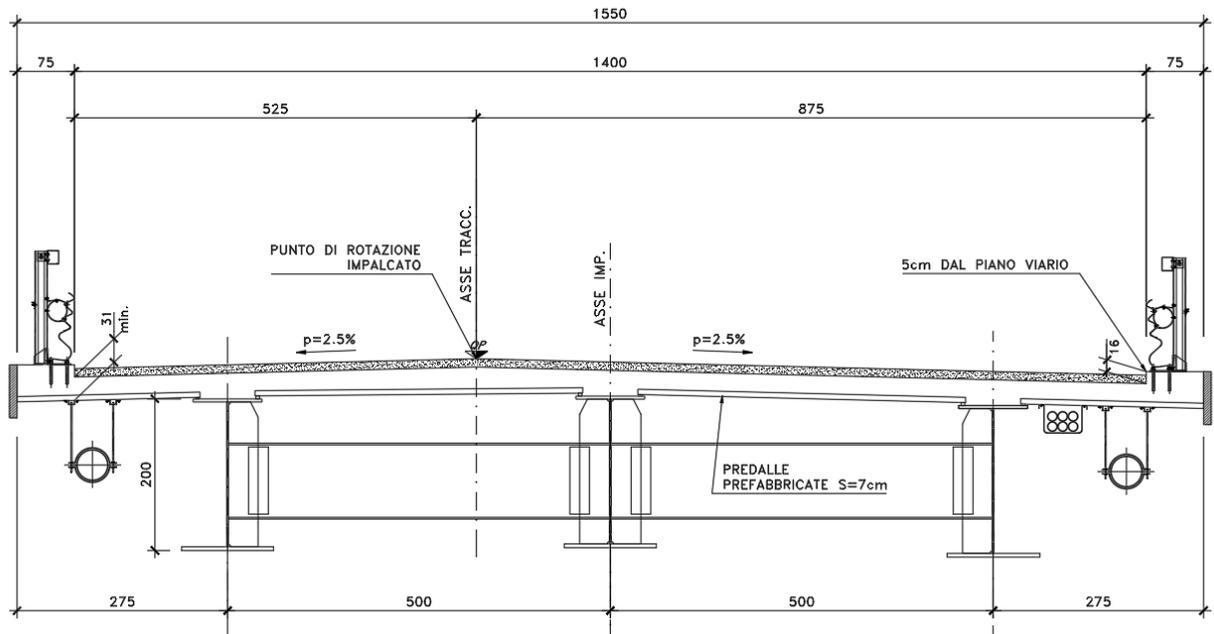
Sezione trasversale impalcato in campata tipo a 3 travi
